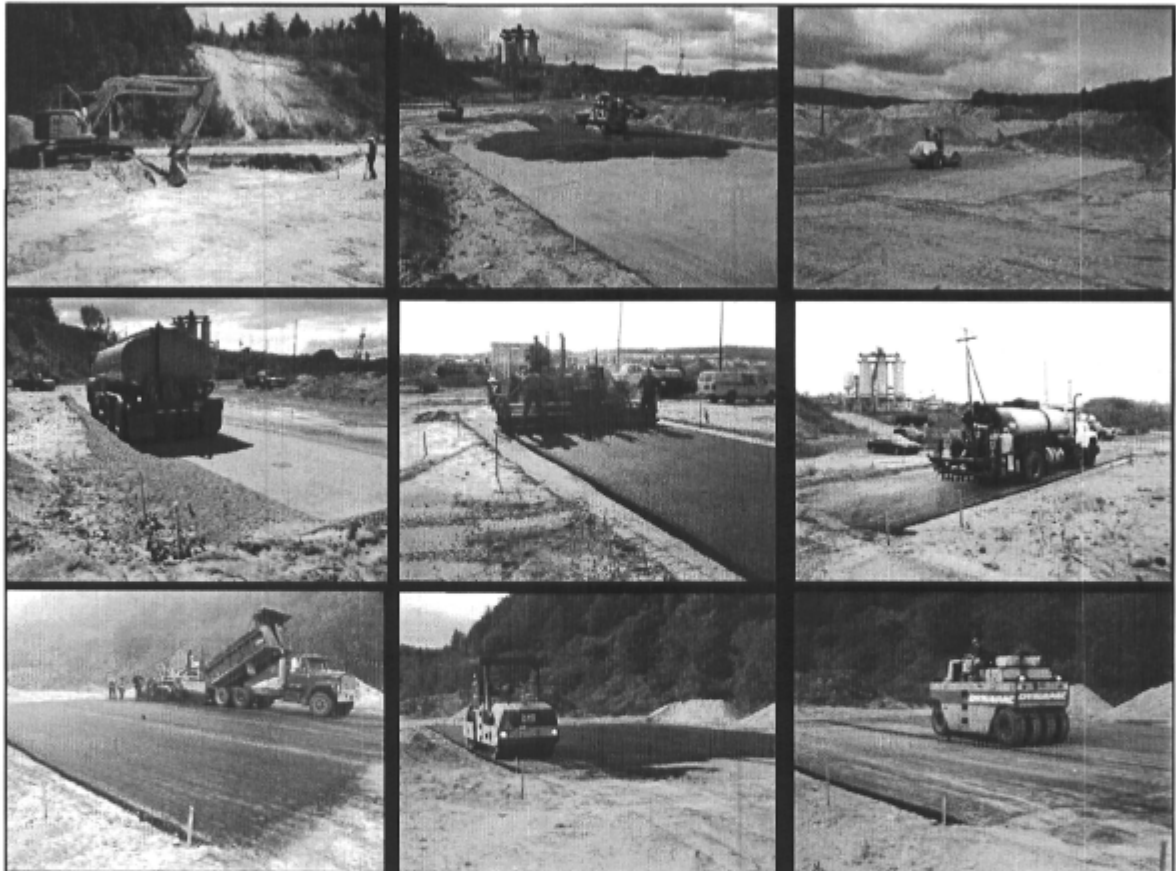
Opération de construction des planches d'essais, de gauche à droite et de bas en haut : excavation de la planche 1, mise en place deuxième couche de fondation sur la planche 1, compactage de la fondation de la planche 1, arrosage en vu du compactage final de la planche 1, pose de la première couche de revêtement sur la planche 2, épandage du liant d'accrochage sur la planche 2 avant la pose de la seconde couche d'enrobé bitumineux, pose de la deuxième couche d'enrobé bitumineux sur la planche 1, compactage du revêtement de la planche 1 à l'aide d'un compacteur à rouleaux vibrants en acier, et compactage final du revêtement sur la planche 1 à l'aide d'un compacteur à rouleaux pneumatiques.
